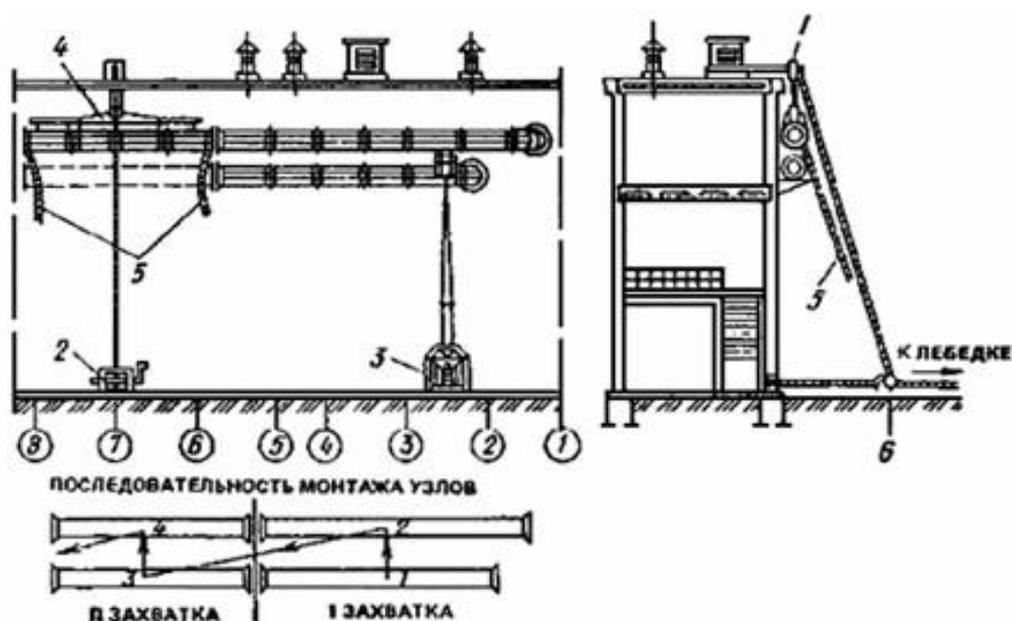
Схема организации рабочей зоны при монтаже воздухопроводов по наружной стене здания:
